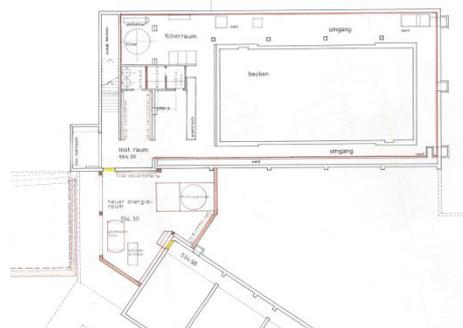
Grundriss UG: Installation- und Technik
